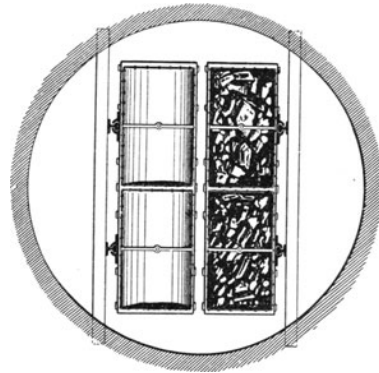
Briartsche Führung mit zwei Einstrichen.
